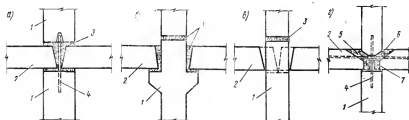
Варианты опирания внутренних несущих стеновых панелей друг на друга и на перекрытия
